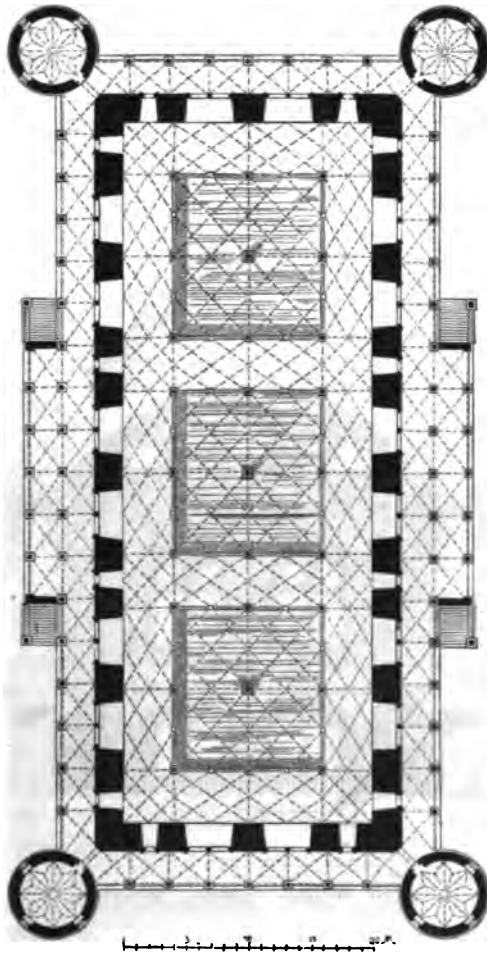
Lusthaus zu Stuttgart. Grundriss.
